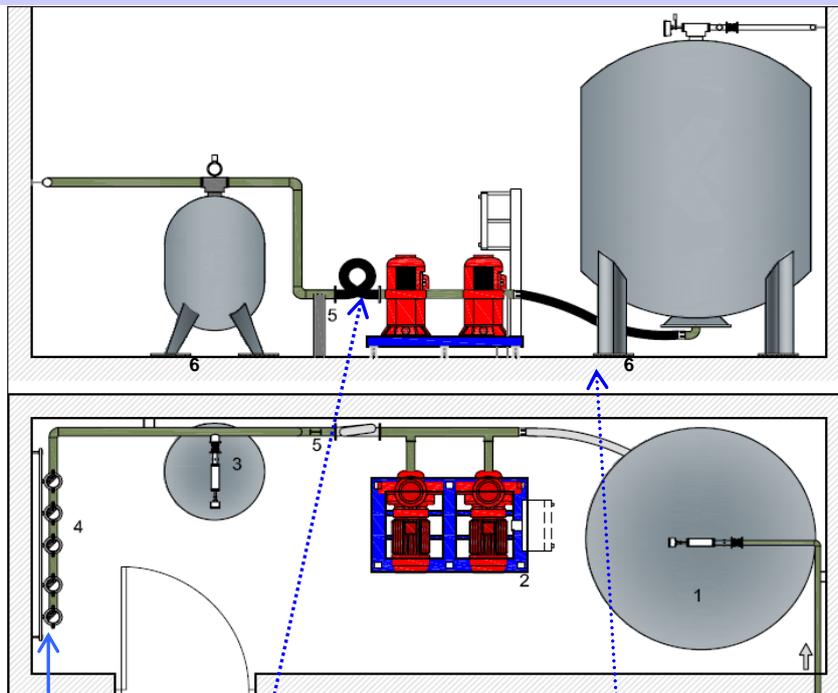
Planta y sección de los componentes de un grupo de presión convencional
